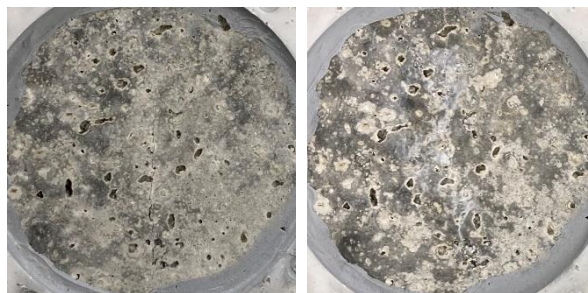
に、各調合の 1 週と 7 週時点での供試体下面のひび割れの様子を示す。
